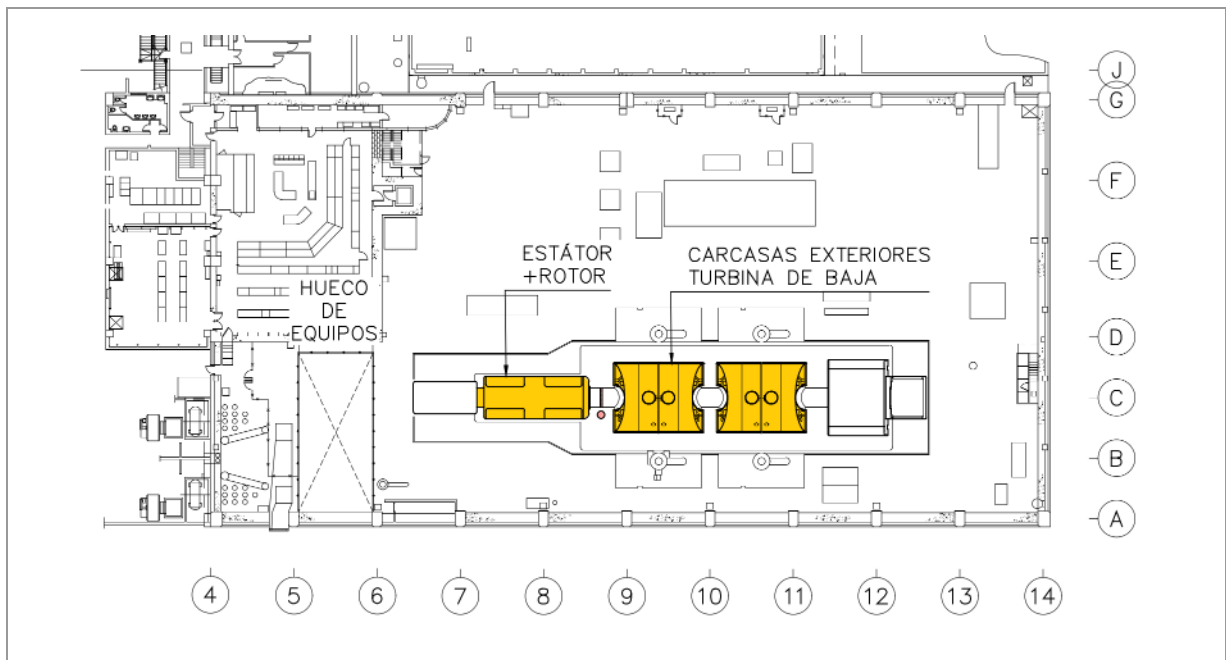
Disposición general planta superior Edificio de Turbina, elevación 524,4
